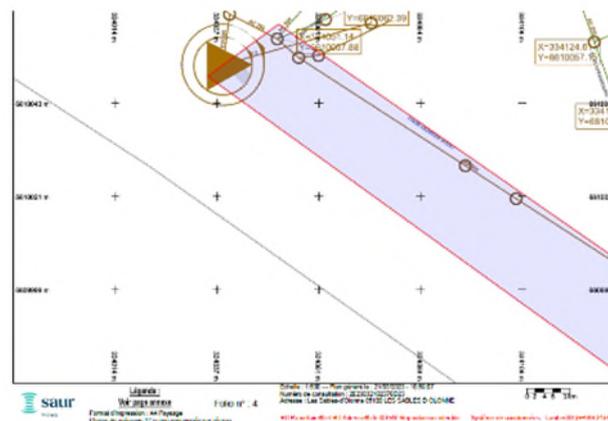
Plan de détail sur la présence d'un poste de relevage sous le belvédère du phare rouge
